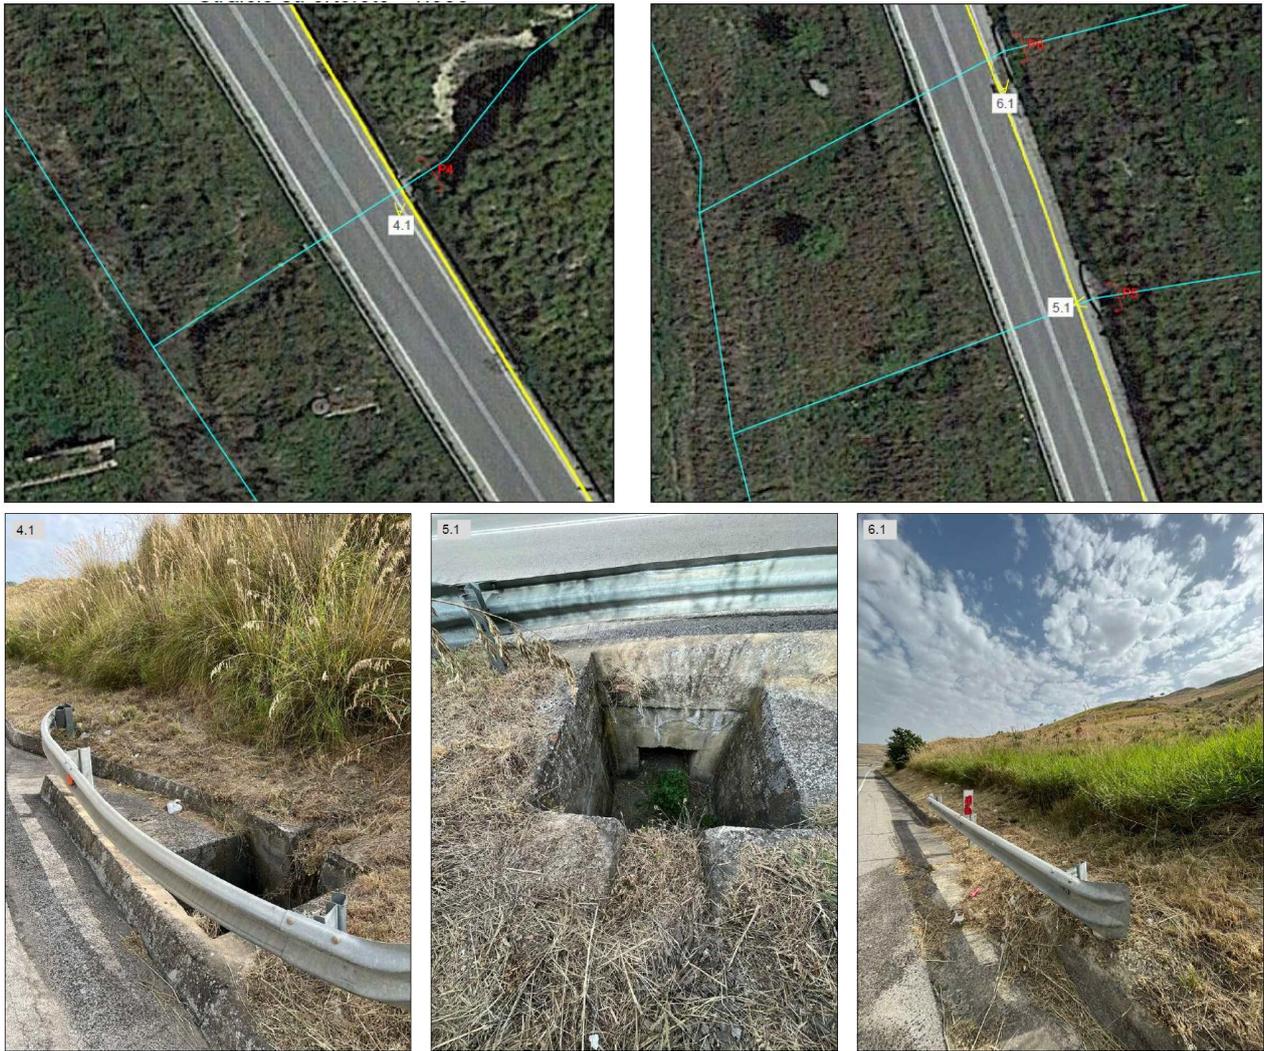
Attraversamenti n. 4, 5, 6 - Stralcio su ortofoto e foto
